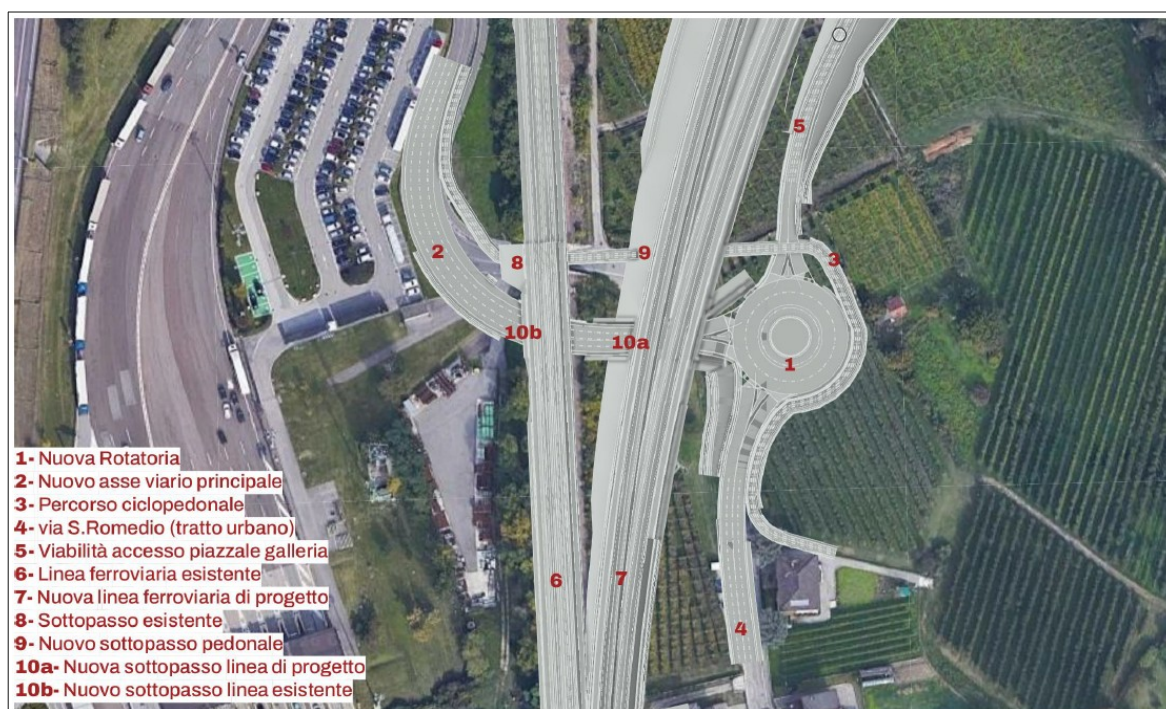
Stralcio planimetrico della viabilità di progetto nell'area di Via S. Romedio (figura 36 della documentazione di progetto, elaborato "Relazione di progetto")
